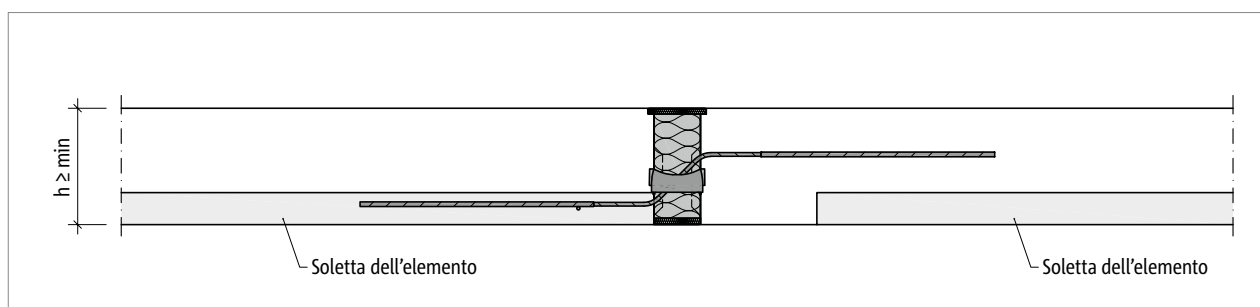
Schöck Isokorb® T tipo QL: solaio prefabbricato con Schöck Isokorb® inserito
